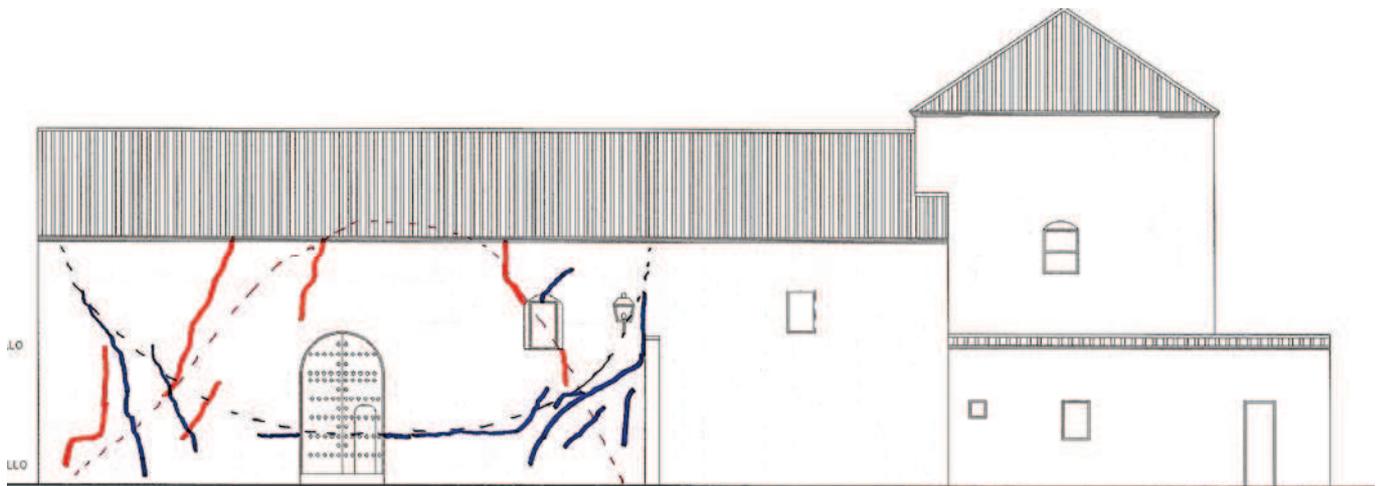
Esquema de fisuras y grietas en los dos paramentos del muro de fachada lateral.
